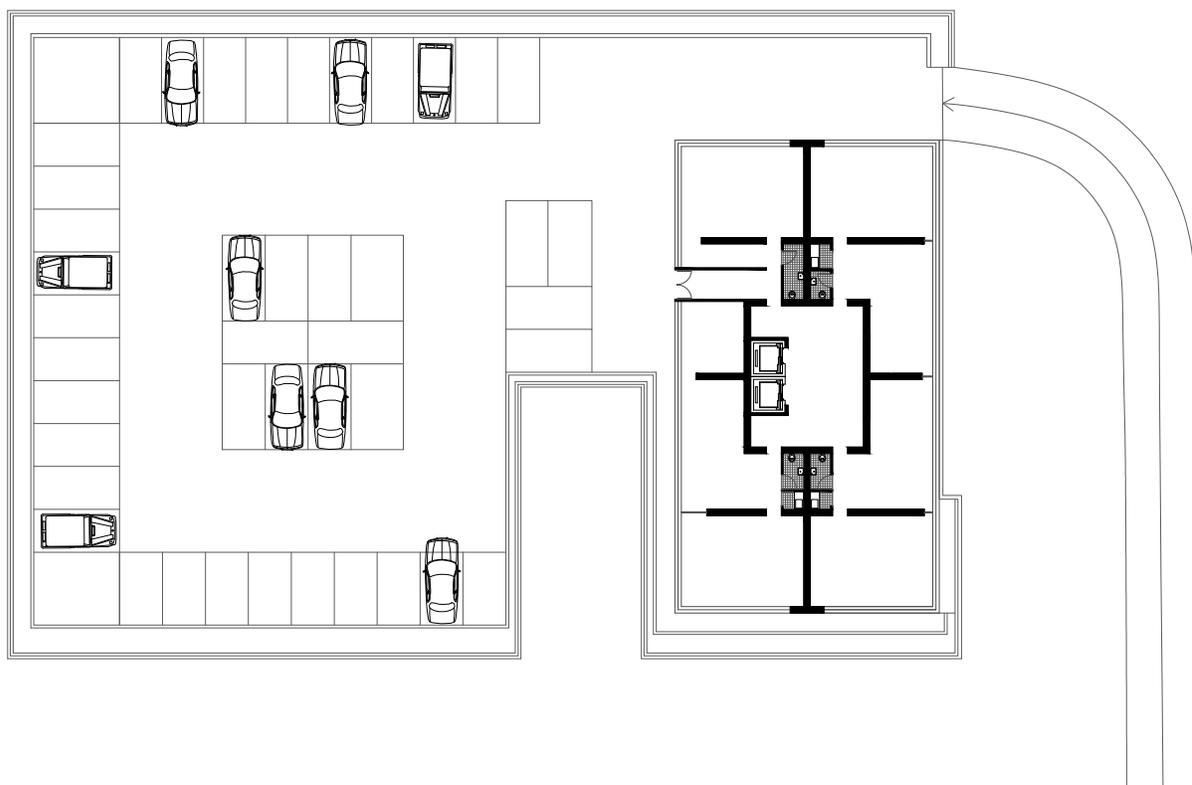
Planta 2º Nivel Edificio Terracota. Sobre la placa comercial del Drugstore se ubica un estacionamiento en la azotea dirigido a los usuarios del edificio Terracota. Fuente: Elaboración Propia.
